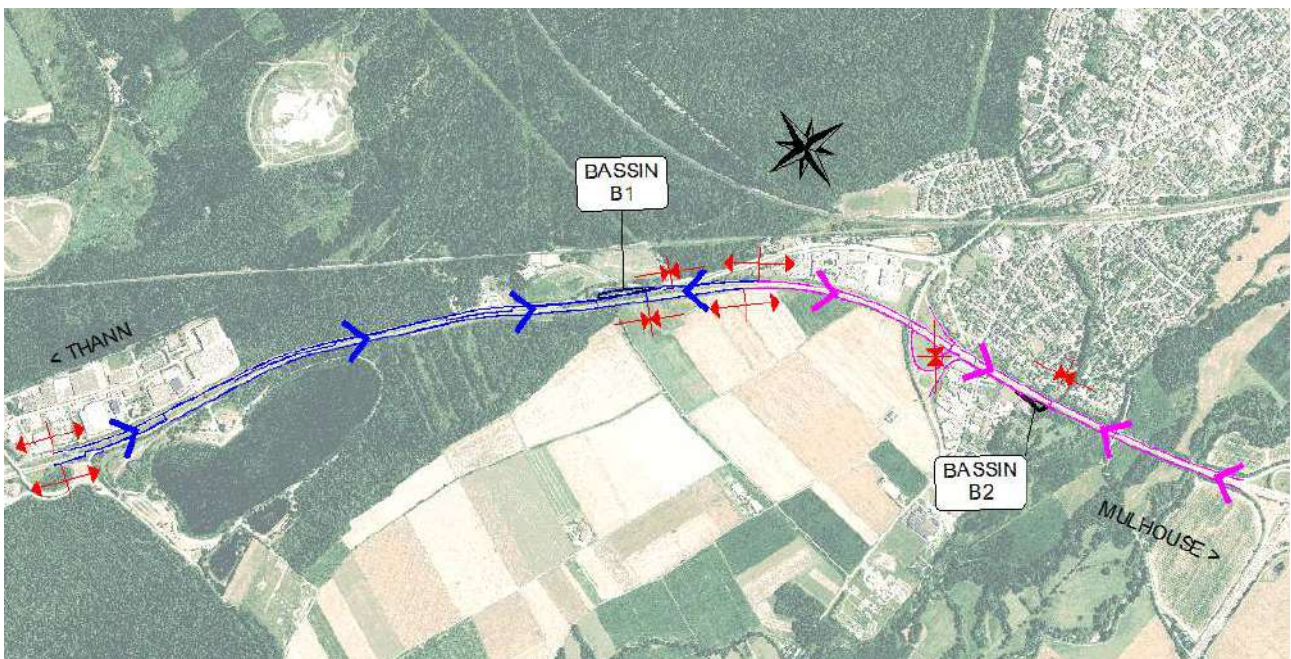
PLAN DU PROJET D'ASSAINISSEMENT DE LA RD1066
